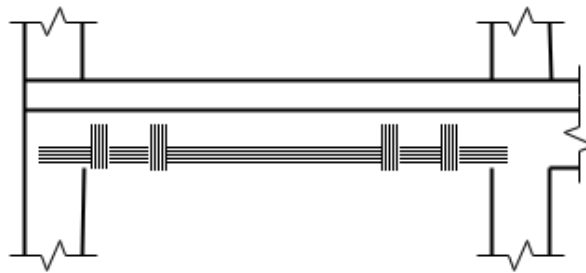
Refuerzo a cortante de una viga de hormigón armado con laminados de material compuesto.
